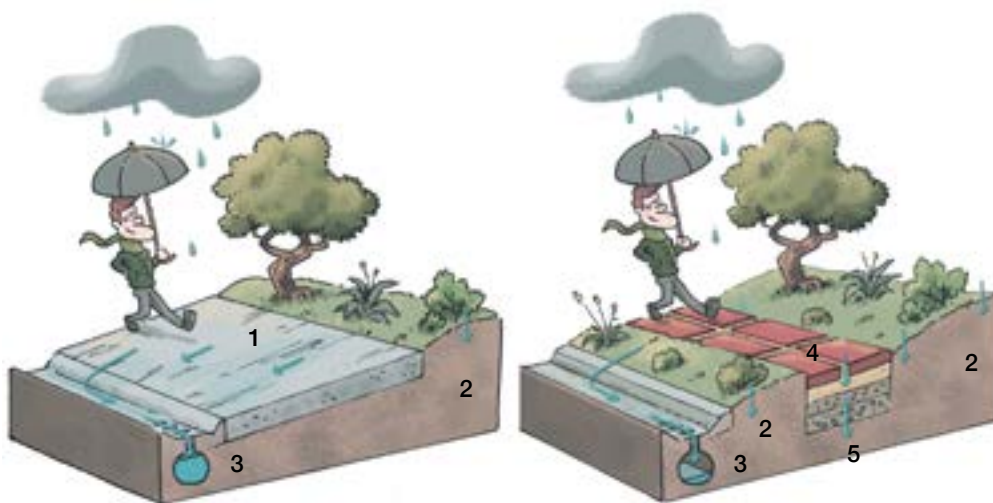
1. Paviment impermeable. 2. Àrea d'infiltració. 3 Recollida d'escorrentiu. 4. Paviment permeable: lloses amb junta oberta. 5. Base drenant i d'infiltració.
